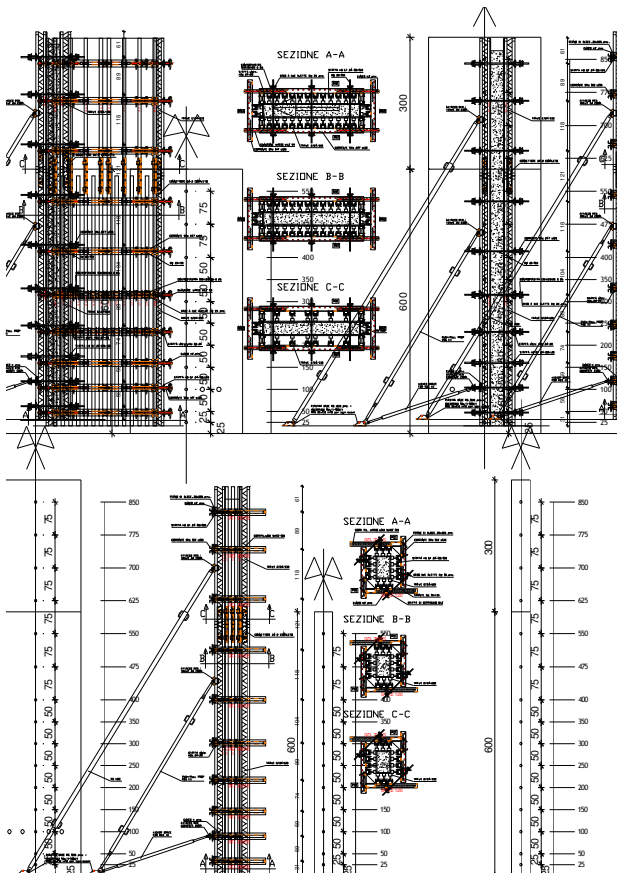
Progetto delle casseforme: parete e colonna. Disposizione dei sensori.
